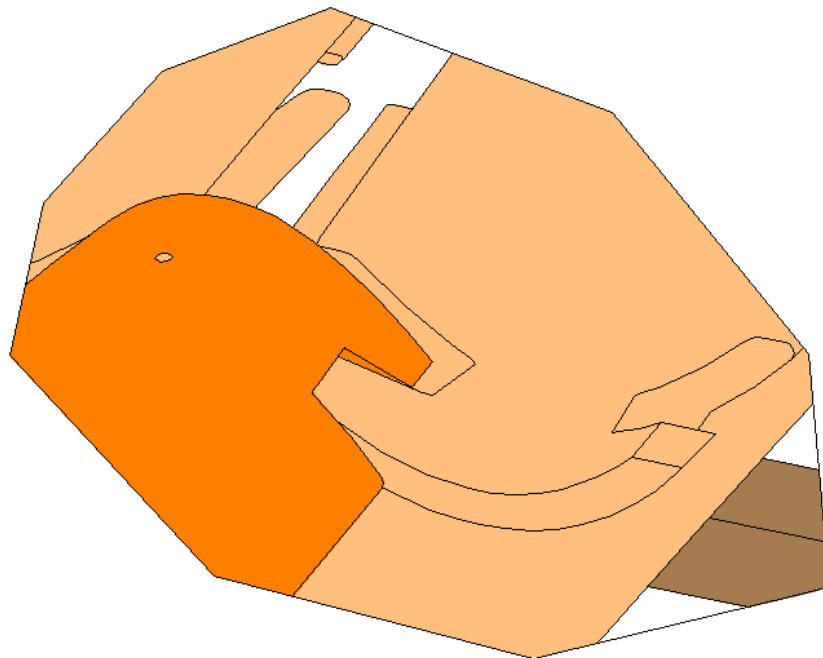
Montage tuiles Canal'di : détail verrouillage
